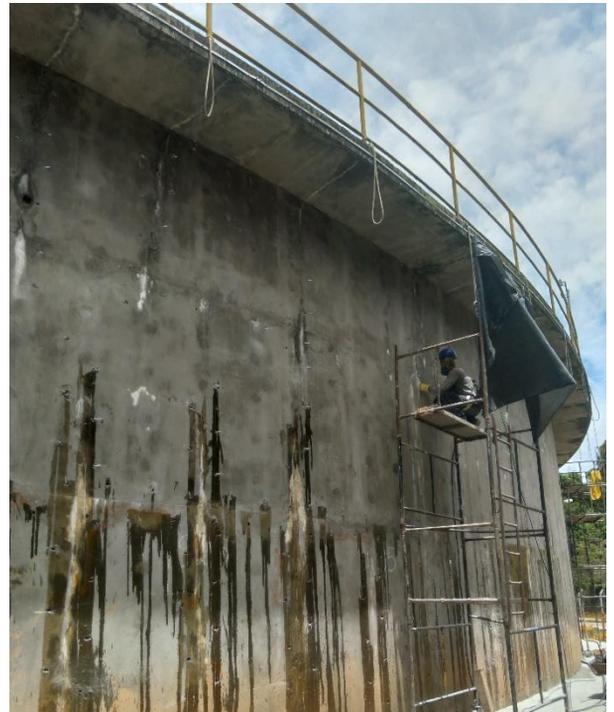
Tratamento das fissuras com sistema de injeção Aqua Dam Gel BR e Aqua Dam PU BR
